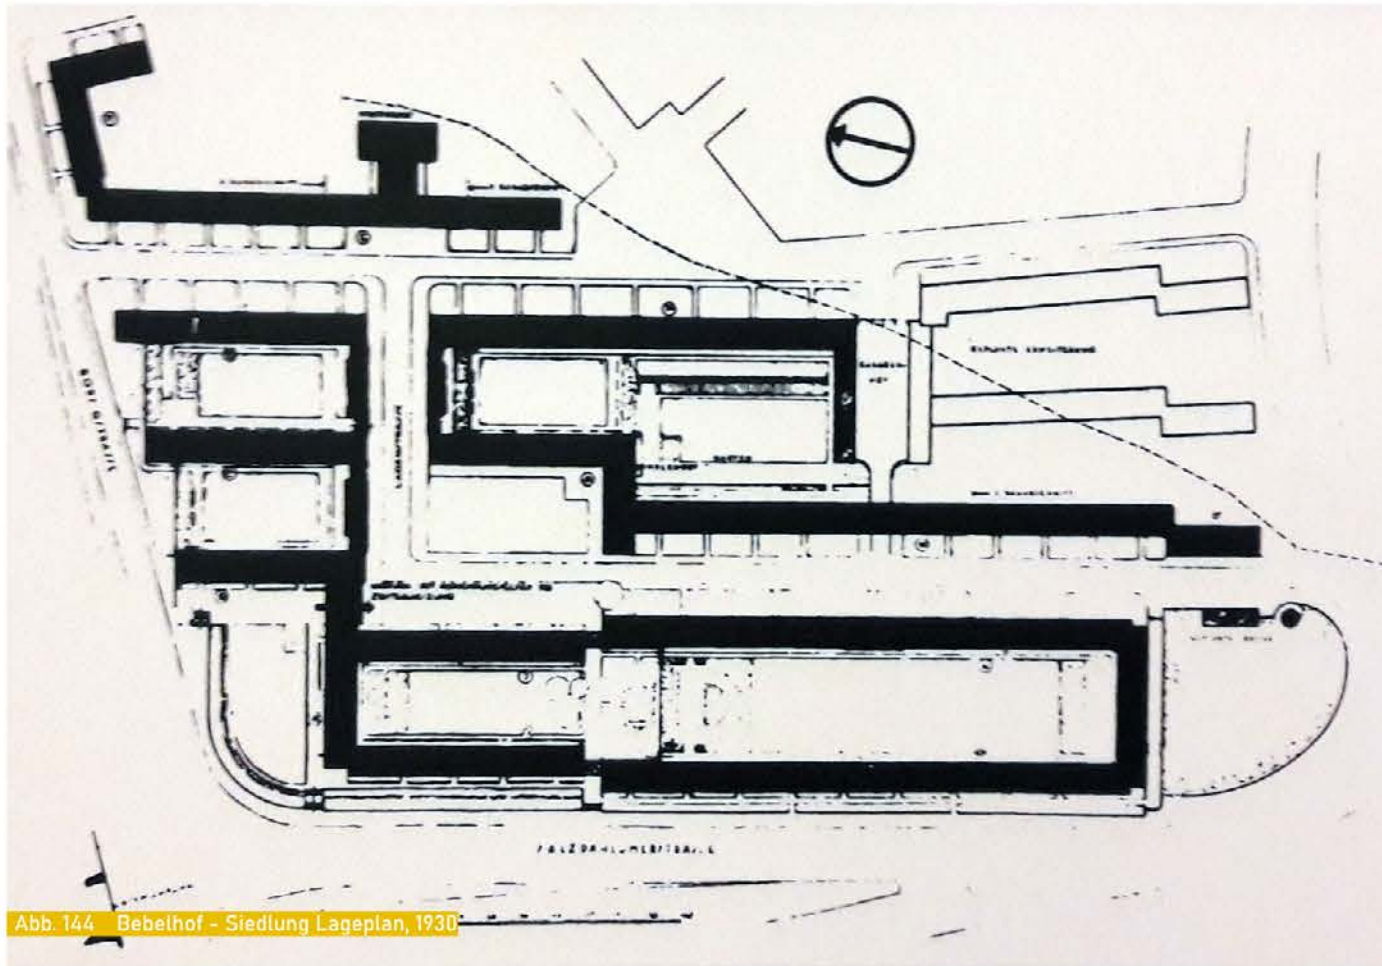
Bebethof - Siedlung Lageplan, 1930
